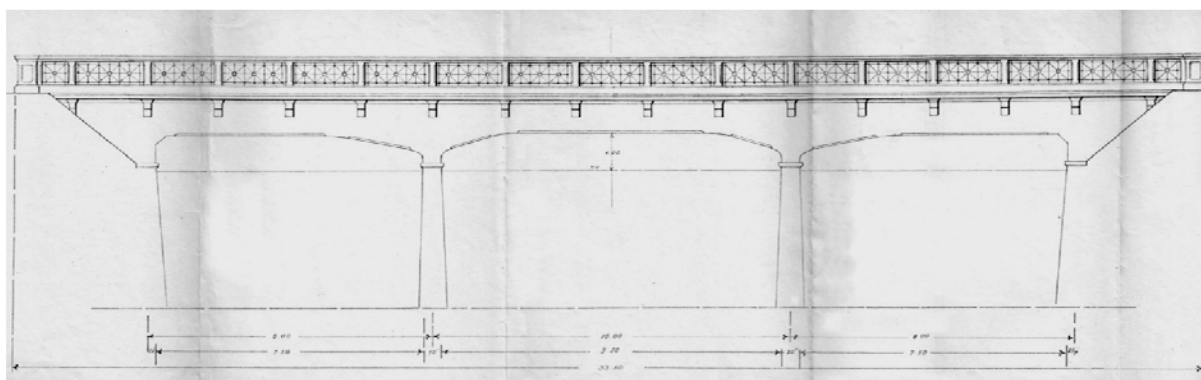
Grafico di progetto del nuovo (terzo) ponte delle Teste in conglomerato cementizio armato.
